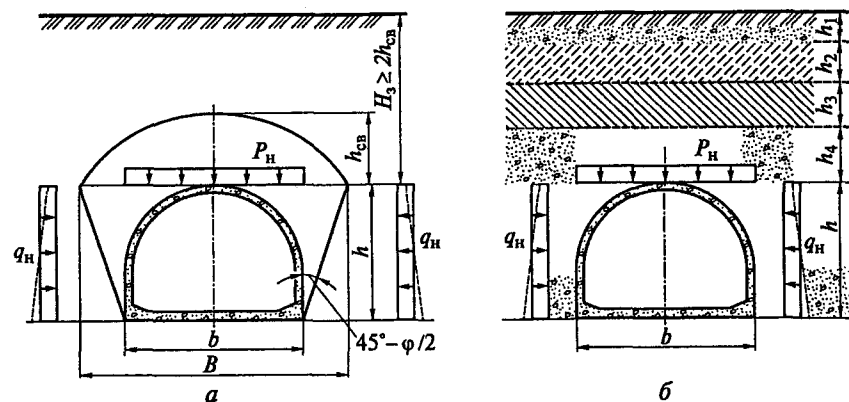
Схемы для определения давления грунта на обделки тоннелей по сводообразованию (а), по весу вышележащей толщи грунта (б)
